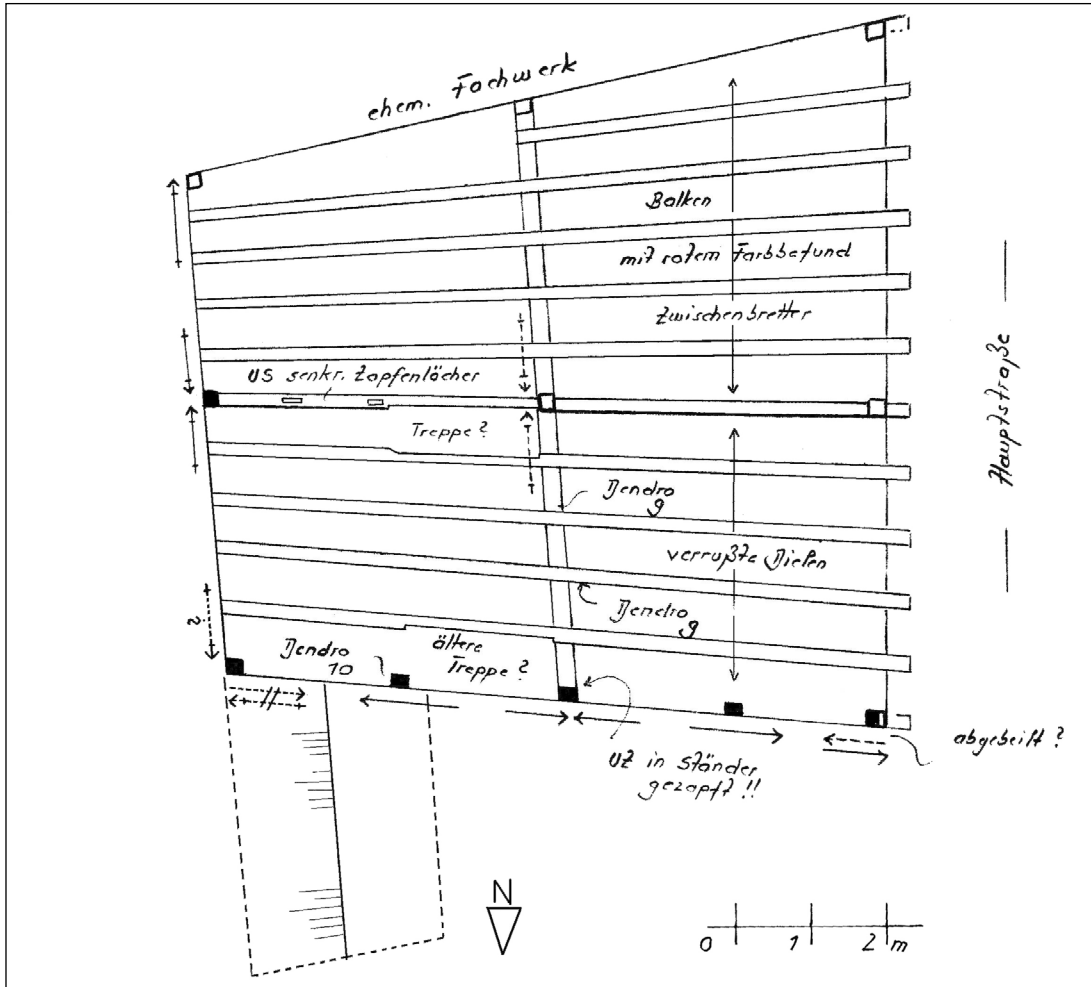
Hauptstraße 15, Grundriss 2. Obergeschoss.
